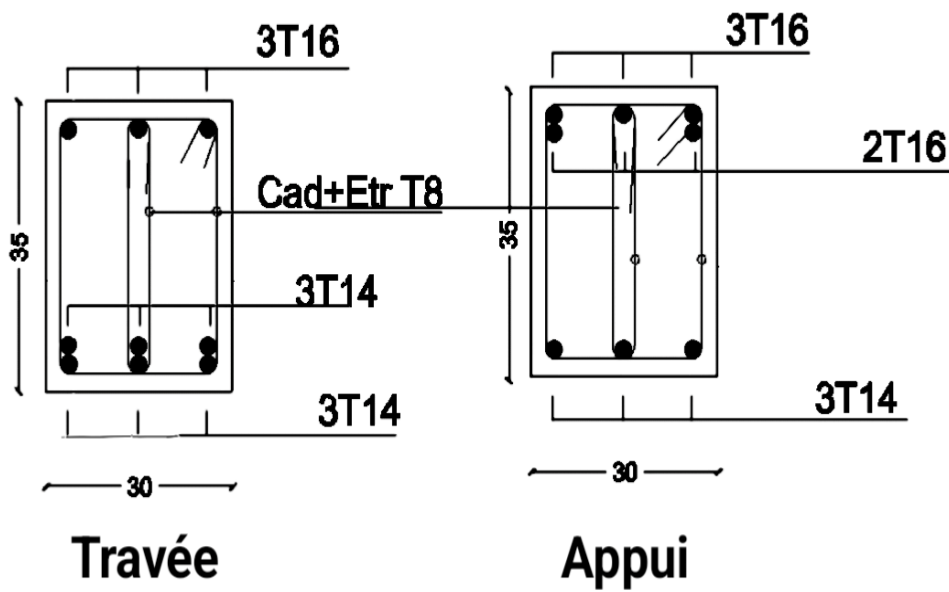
Ferraillage des poutres secondaires de l'Etage courant, RDC.
